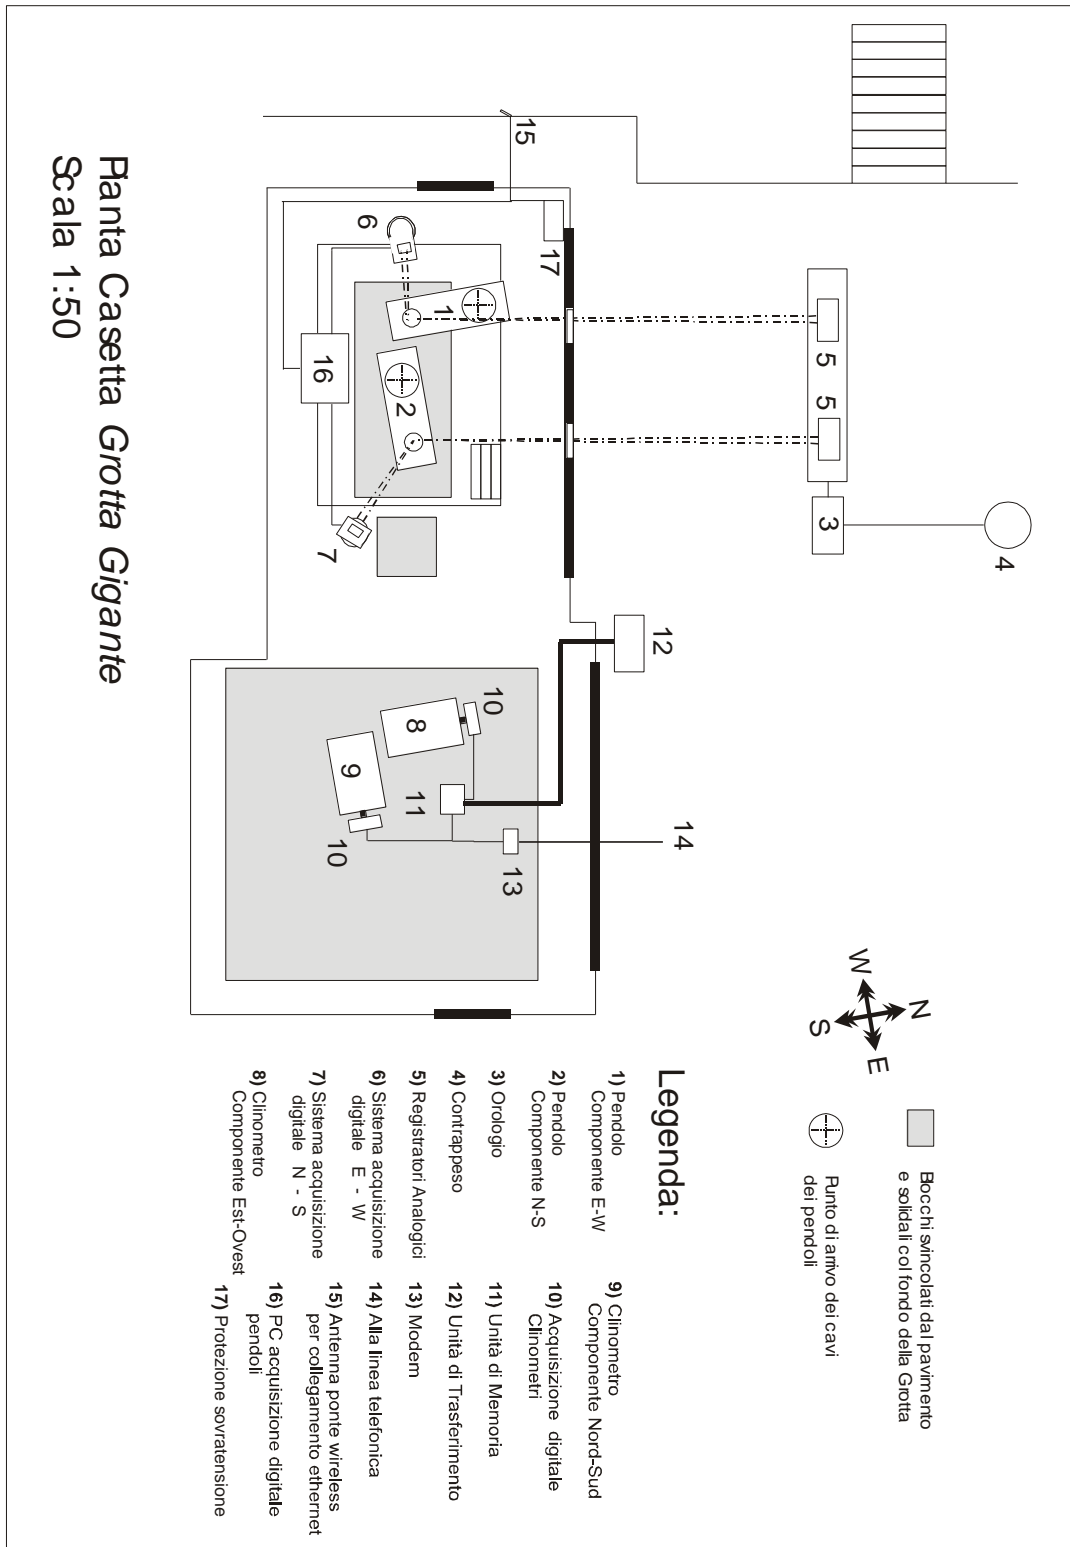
Pianta schematica della strumentazione presente nell'edificio sito in fondo alla Grotta Gigante.
